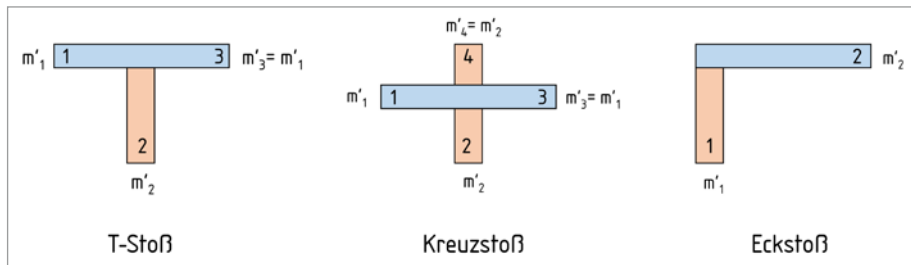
Stoßstellen mit Bezeichnungen nach DIN 4109-32:2016
